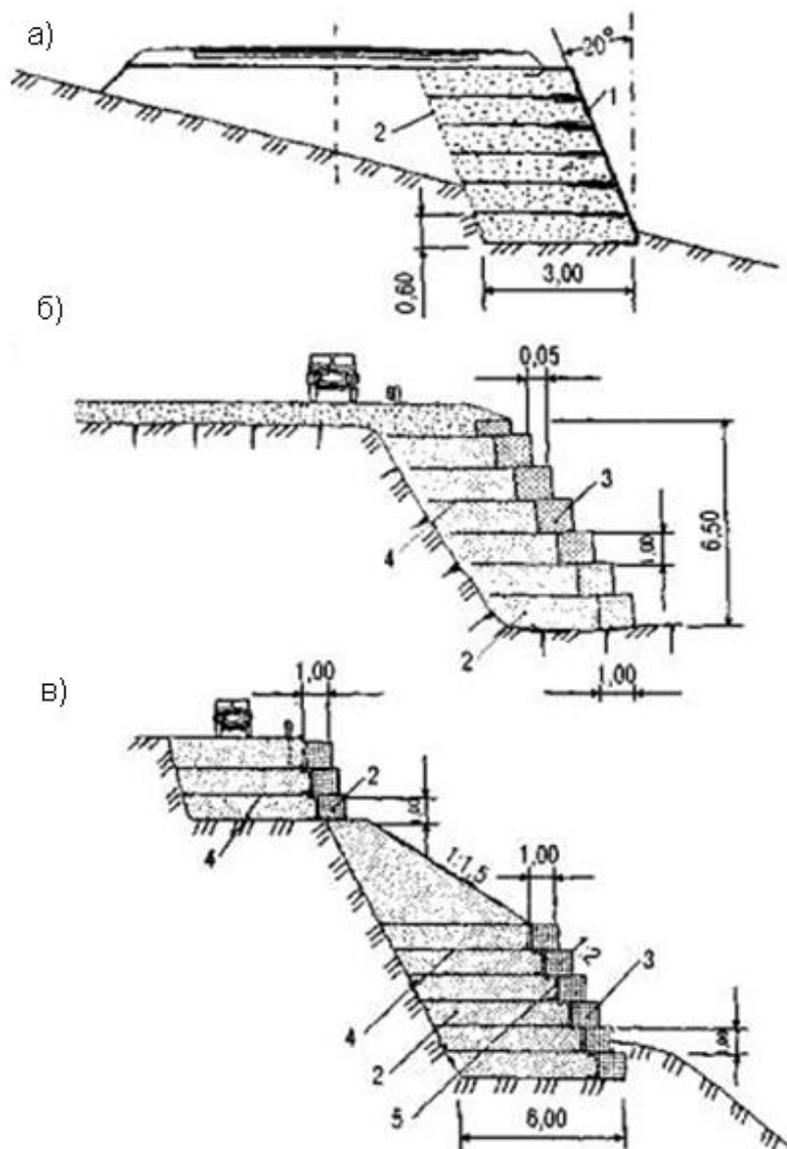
Схемы укрепления откосов и берегов габионными конструкциями:
